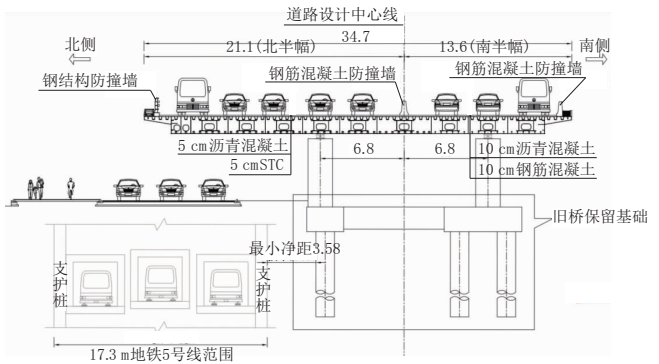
黄埔大道支线第三联钢箱梁横断面布置图 B-B(单位:m)
